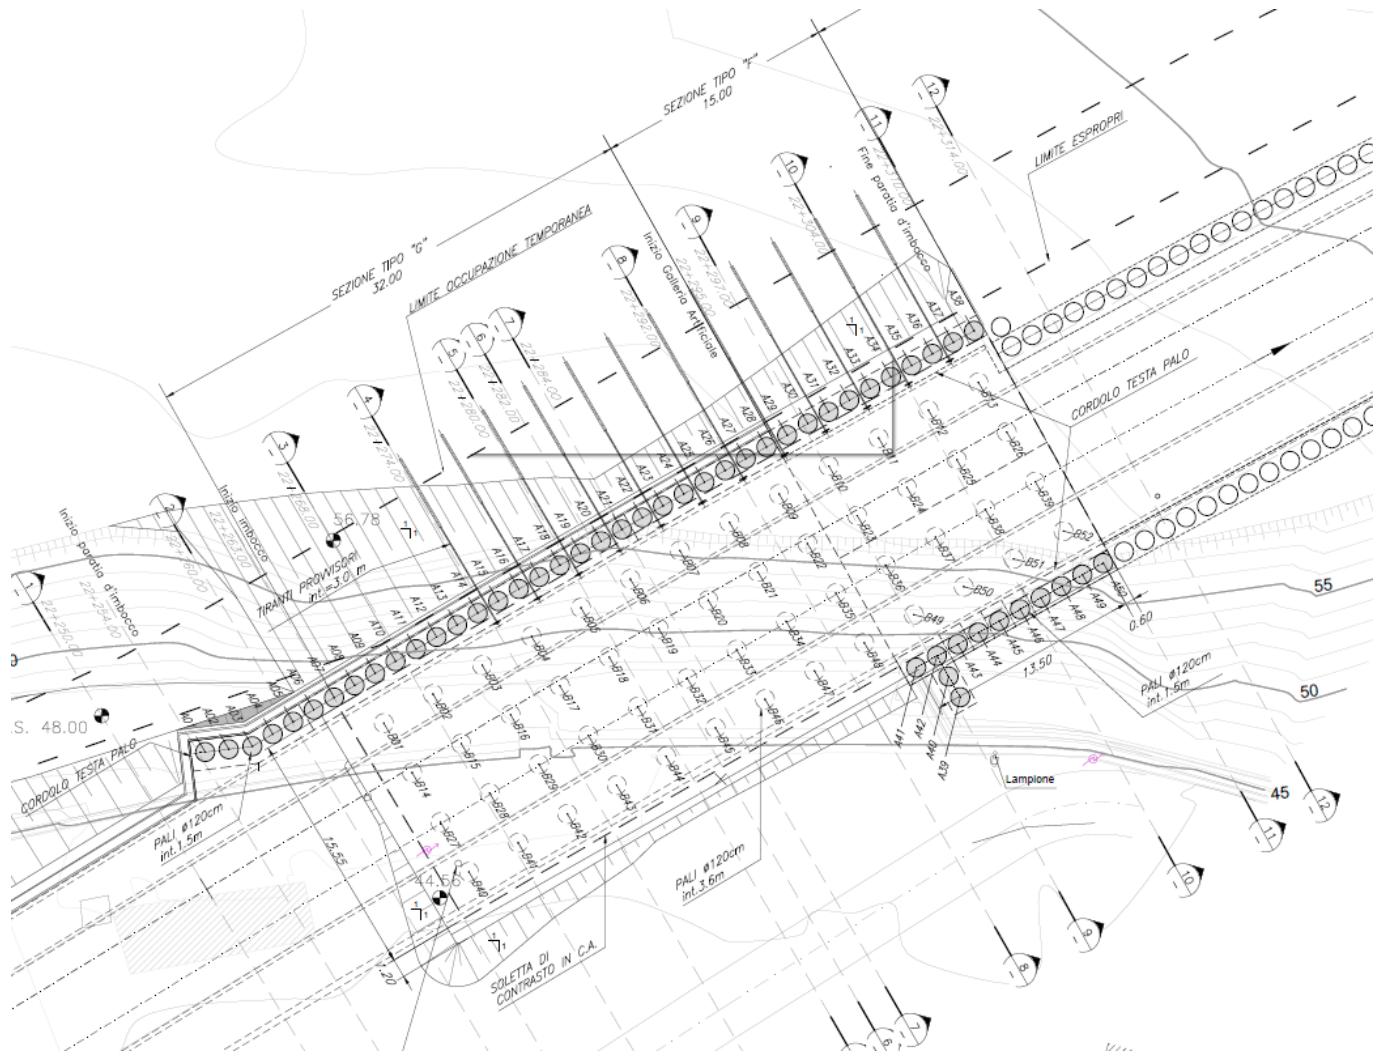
Pianta scavi finale dell'imbocco lato Canello
